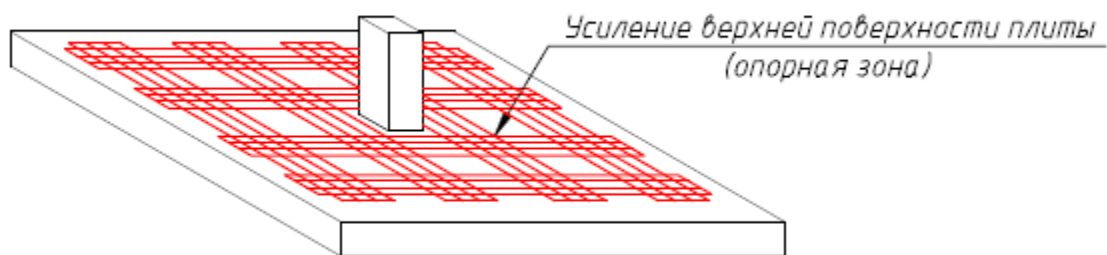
Усиление верхней растянутой (опорной) зоны безригельного перекрытия системой внешнего армирования CarbonWrap®
